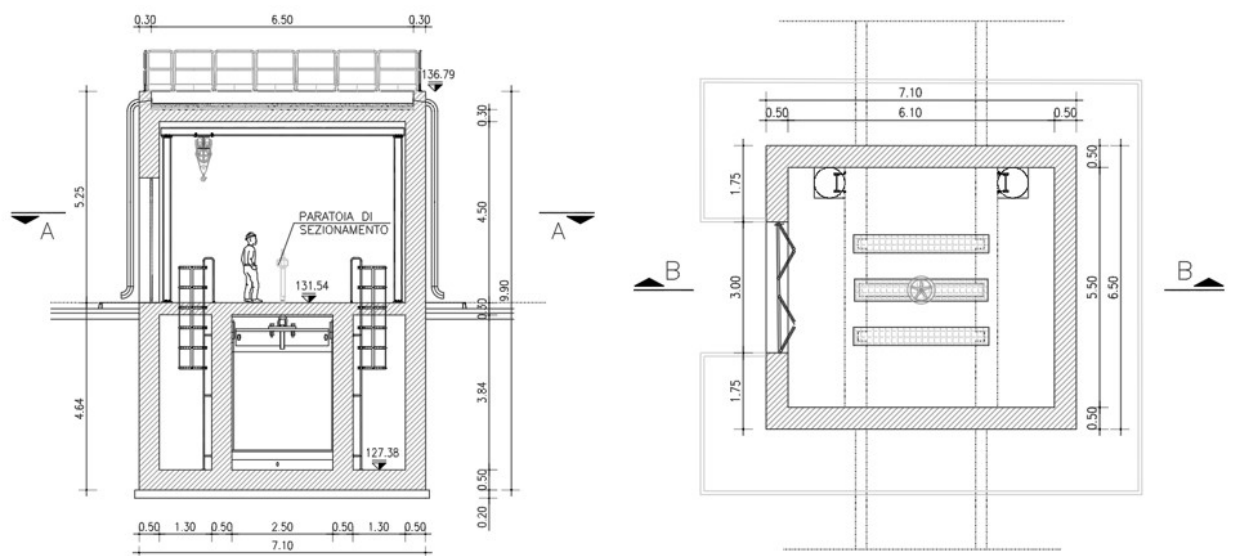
Planimetria di progetto del tratto TC1 interno al centro idrico esistente di Ottavia (Manufatto di Manovra)
